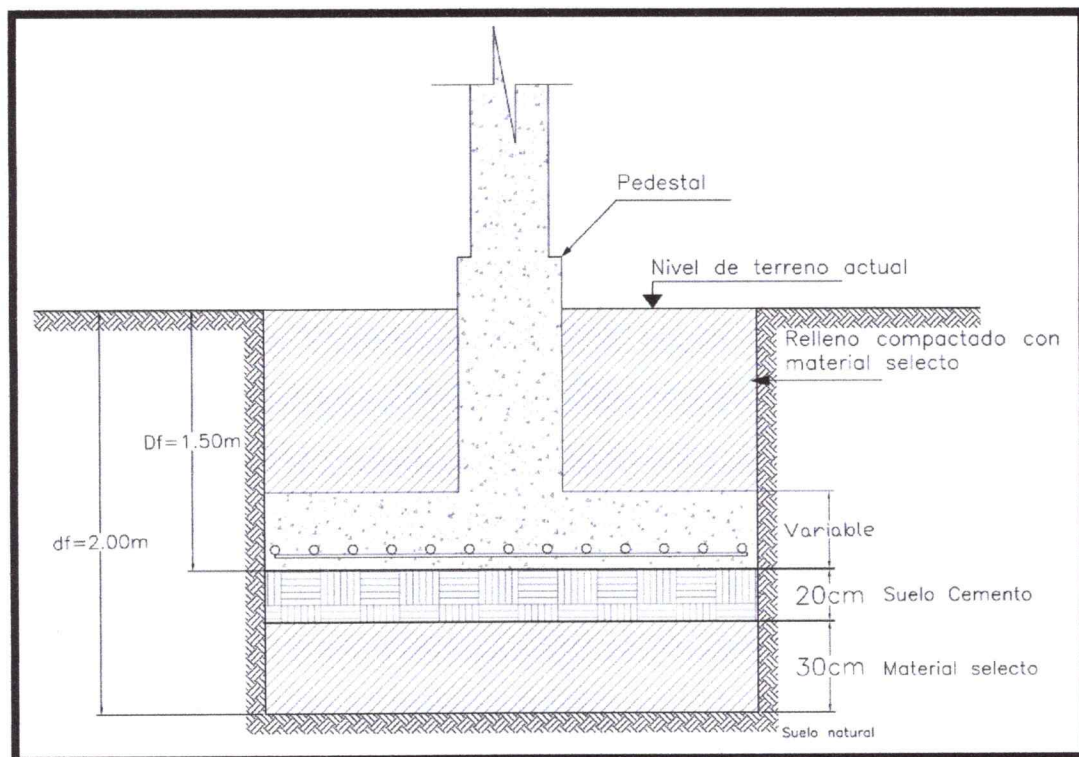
Detalle de propuesta para cimentación y mejoramiento del subsuelo para zapatas.
